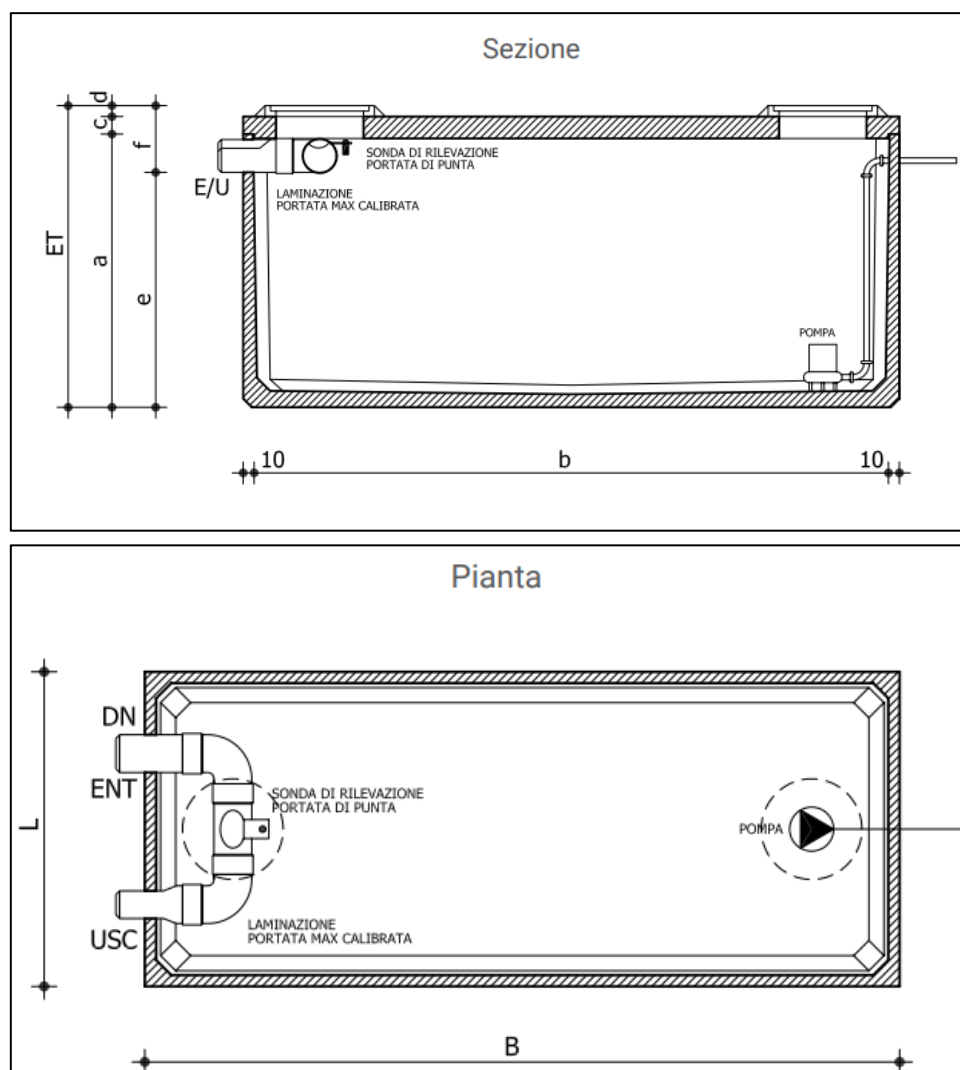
Pianta e sezione tipodel manufatto previsto (Fonte Catalogo Pircher 2021).
